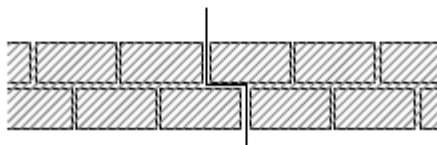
Junta de movimiento con solape. Esquema en planta
